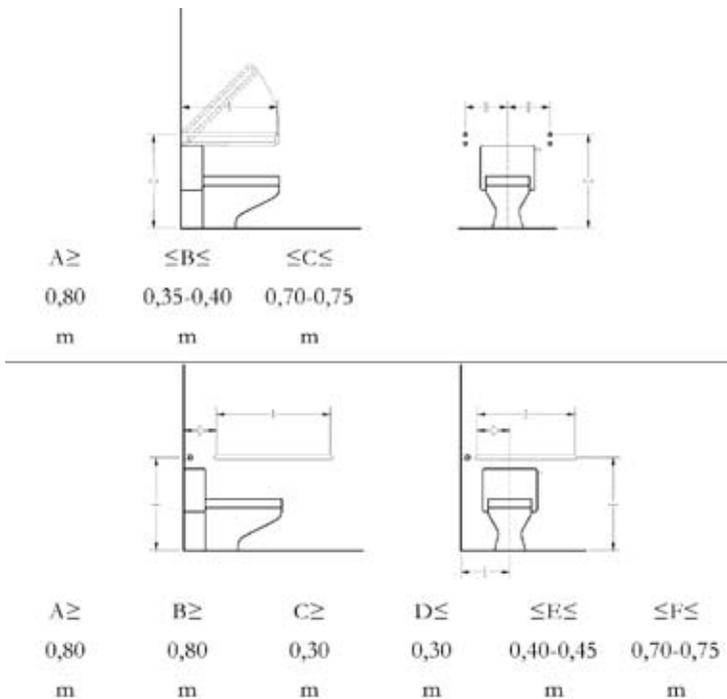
Localização e dimensões de barras de apoio junto à sanita acessível.
